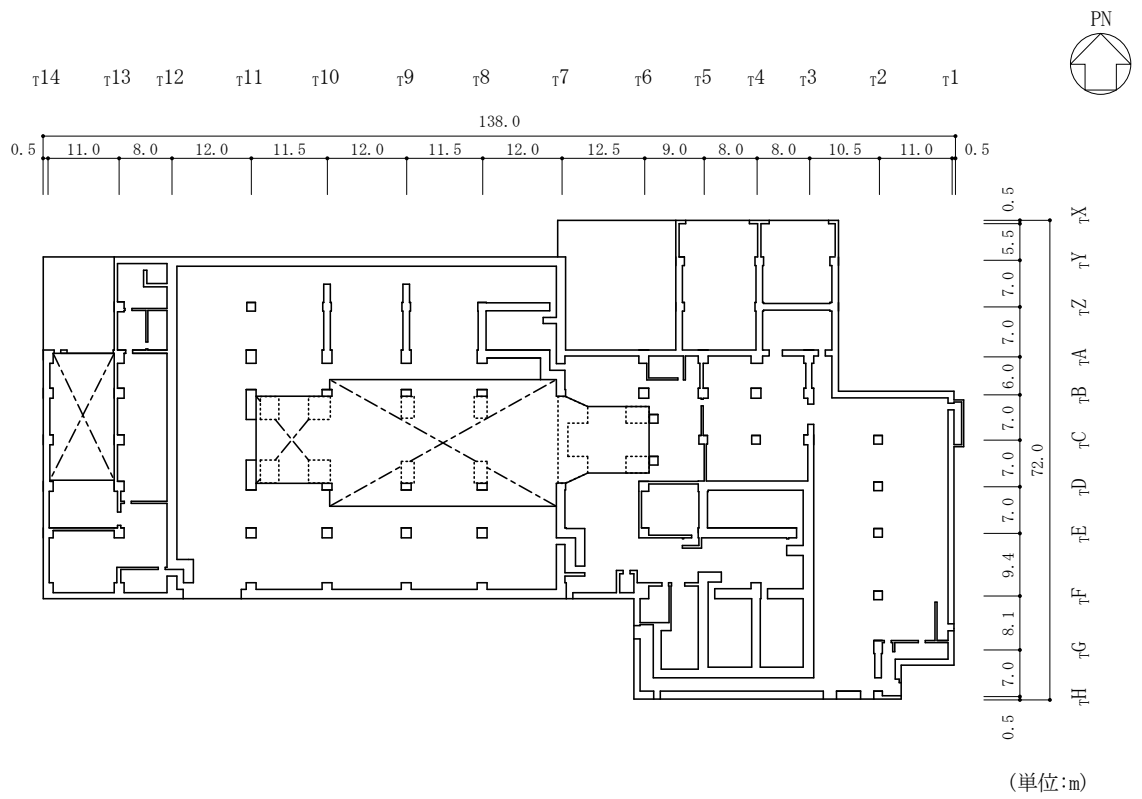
(1) タービン建物の概略平面図 (EL 12.5m)
